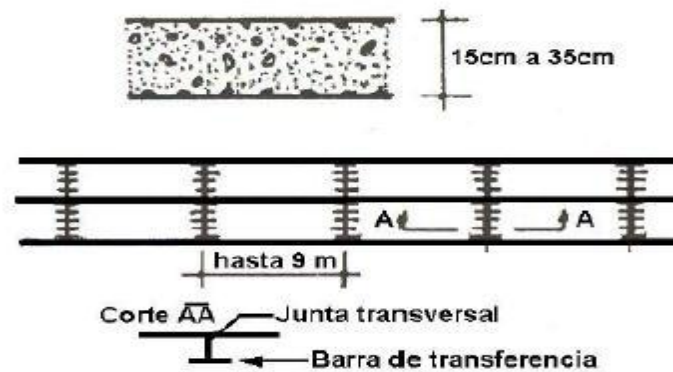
Pavimento de Concreto Simple con Pasadores.
